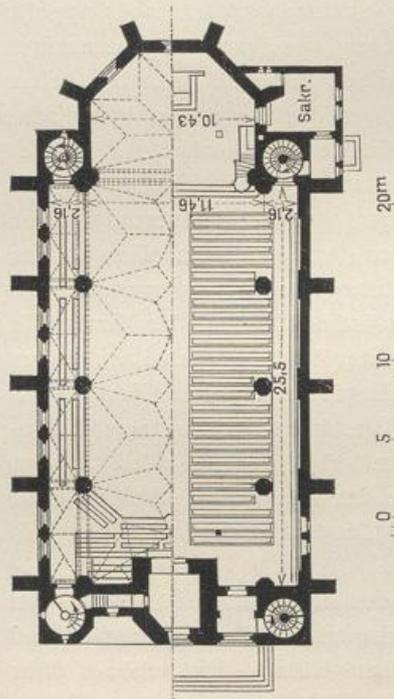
Grundrisse vom Erdgeschoß und Emporengeschoß.
